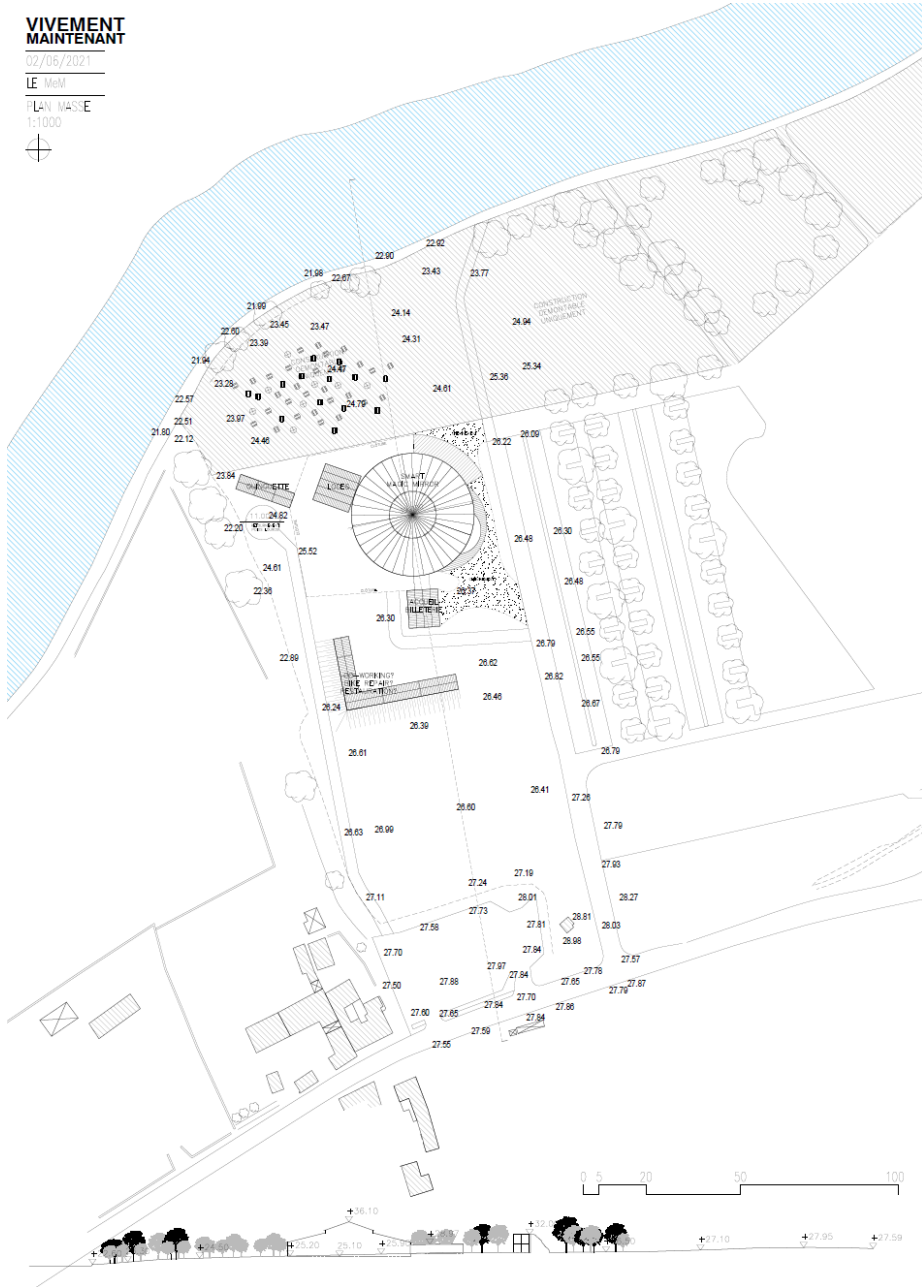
plan masse du scénario à l'ouest des parkings – source : Vivement Maintenant
